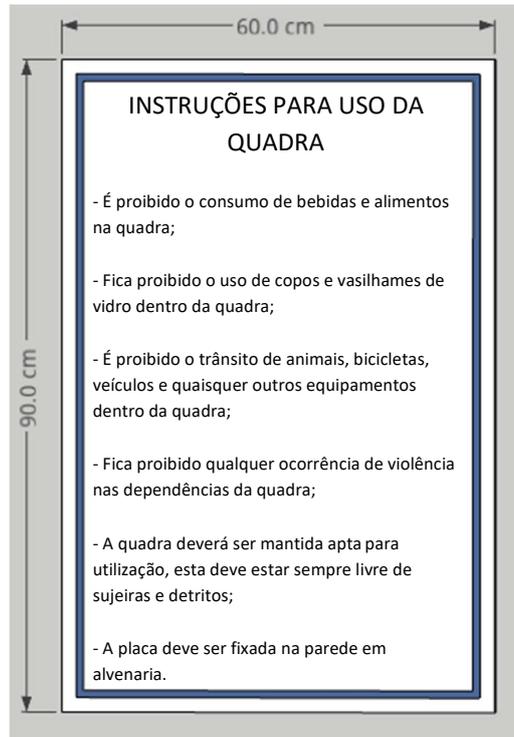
Detalhe Ilustrativo de placa de instruções (Fonte: Autor/2025)
